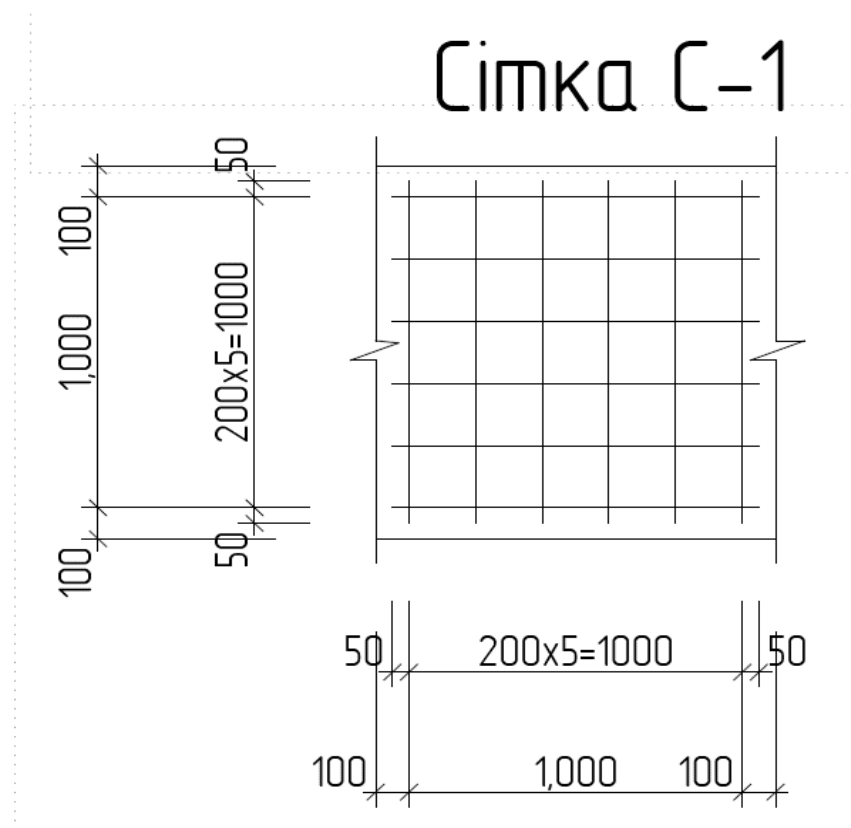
Схема арматурної сітки подушки фундаменту
